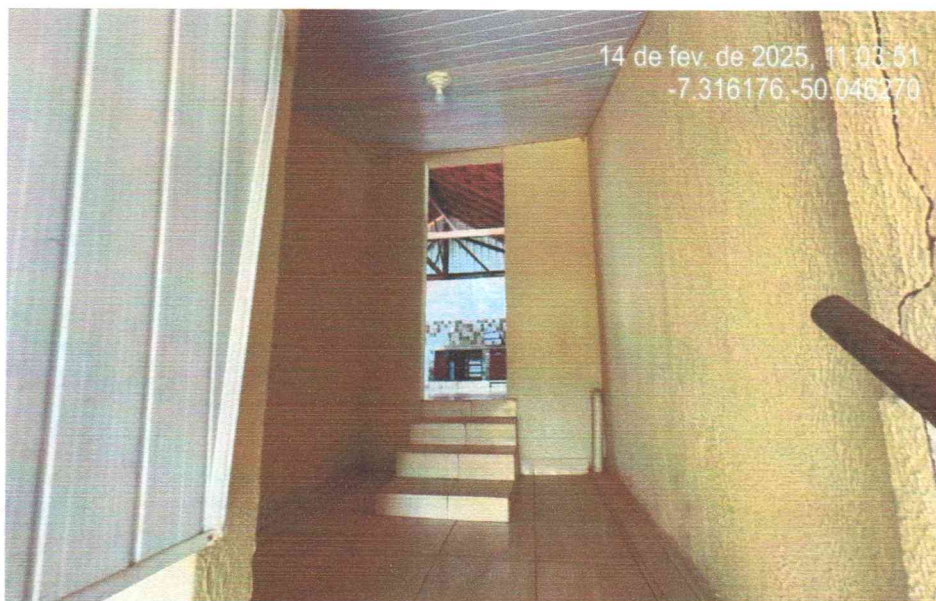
Pav. Superior: Hall de Entrada Cozinha
